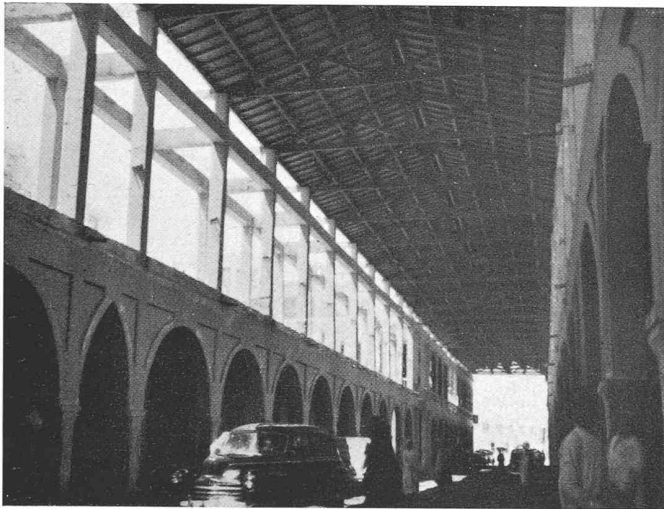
Eisenbetonkonstruktion einer neuen Basarstrasse in Jeddah
